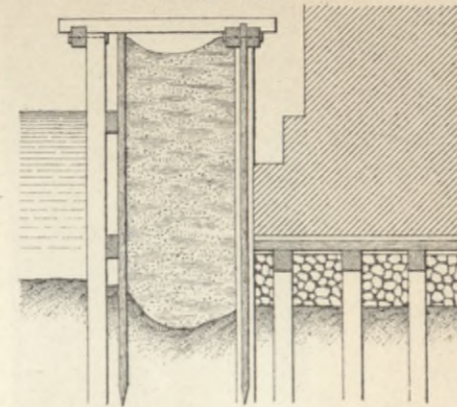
Futtermauer der Docks zu Hull. M. 1:250.
